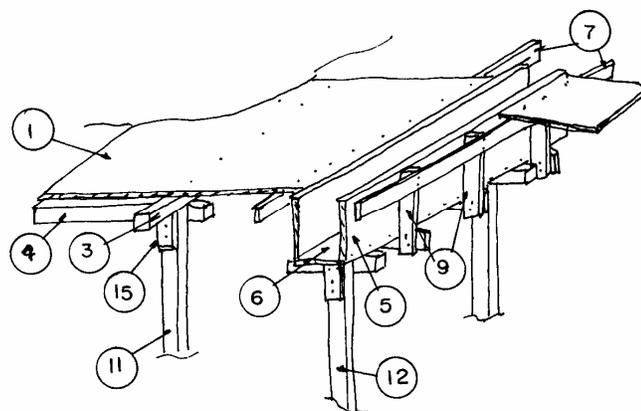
Detalhe de fôrma de vigas de pequena dimensão (Cardão, 1969)
